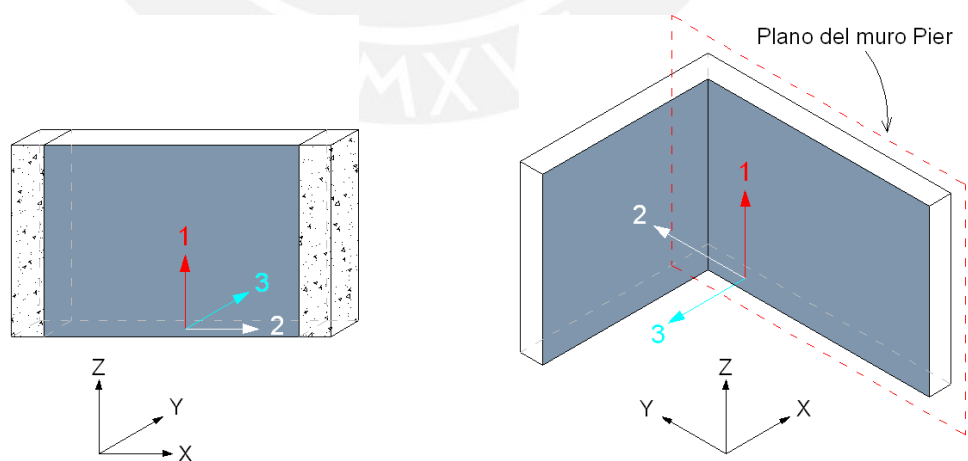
Ejes locales en muros pier bidimensionales y tridimensionales.
